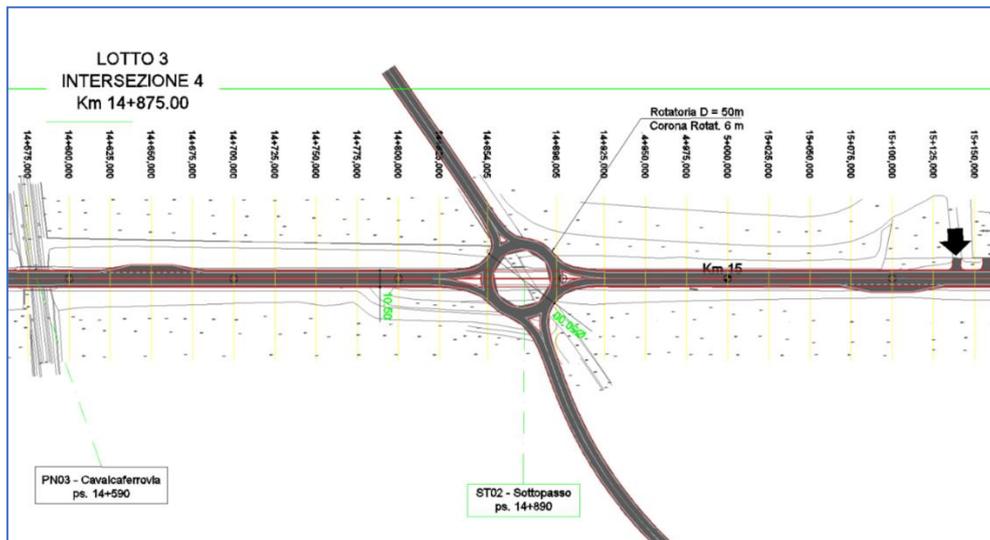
Intersezione 4 - Km 14+875 – Progetto
